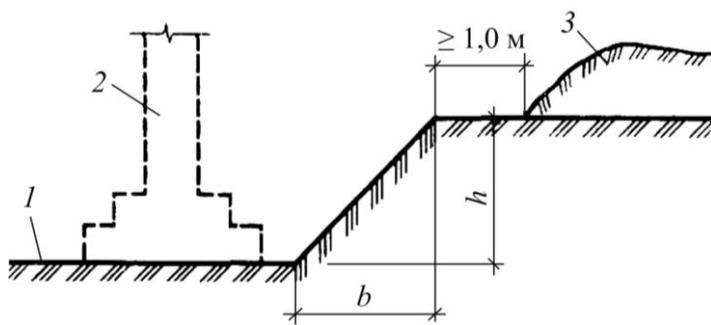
Устройство котлована с откосами из естественного грунта: 1 – дно котлована; 2 – фундамент; 3 – извлеченный грунт
